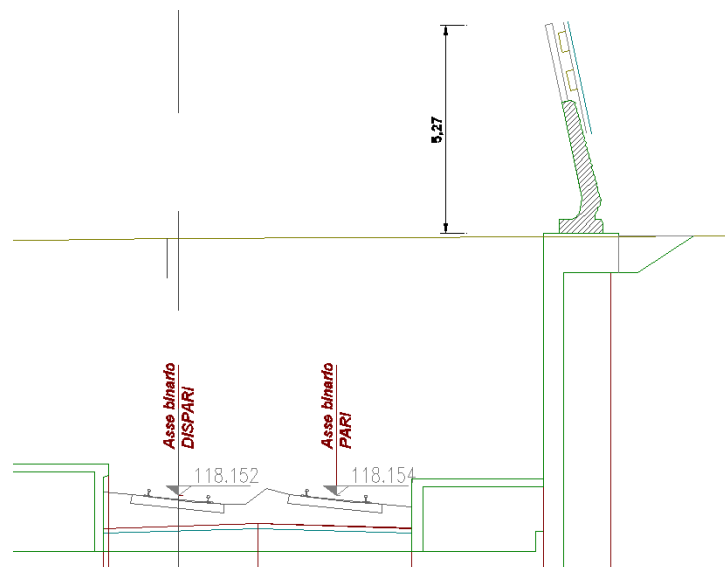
Sezione di progetto barriera standard su muro di sostegno
